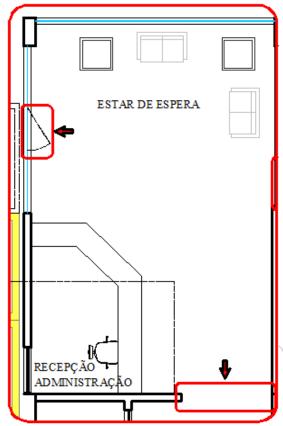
Planta Baixa - Pavimento térreo (2)
